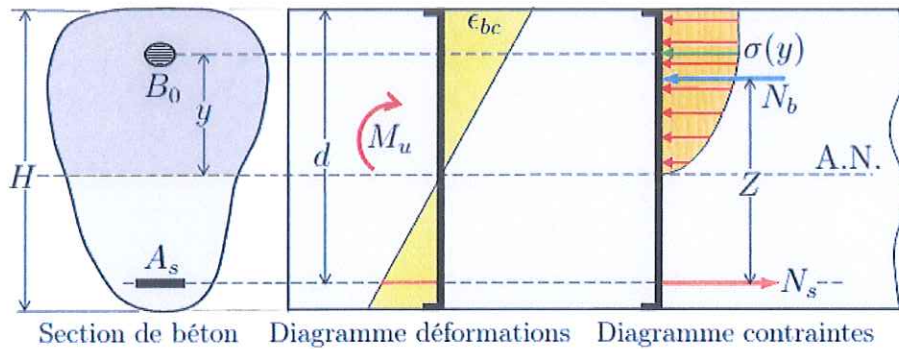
Section d'une poutre sollicitée en flexion
